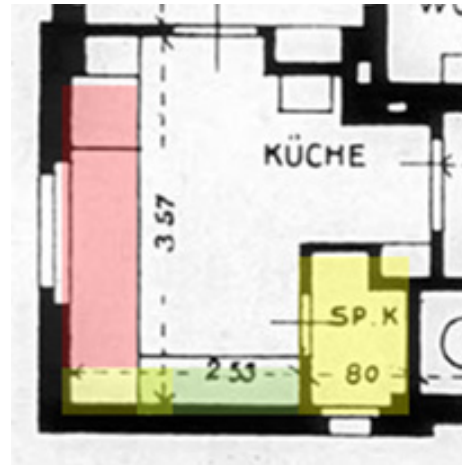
Planta y detalle "Das Hause am Horn" (Casa Modelo). Alemania 1923
